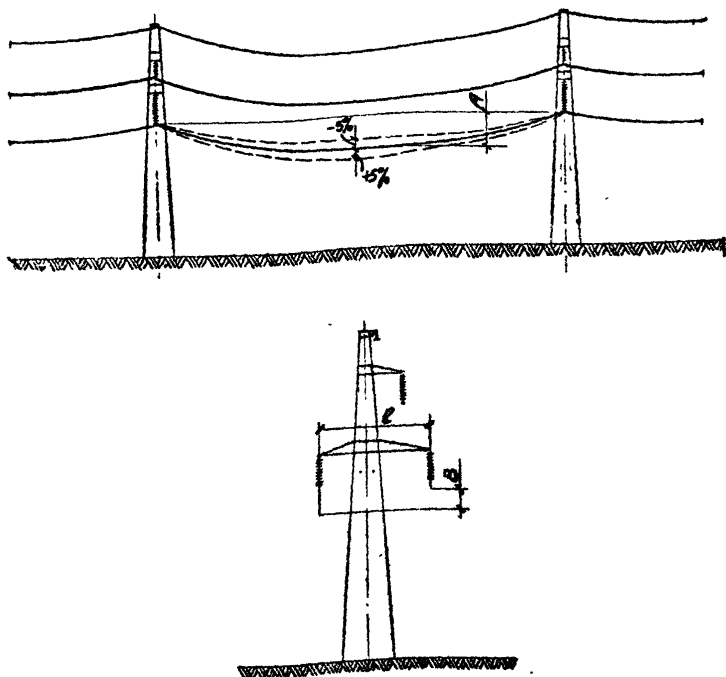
Нормы и допуски на монтаж проводов
